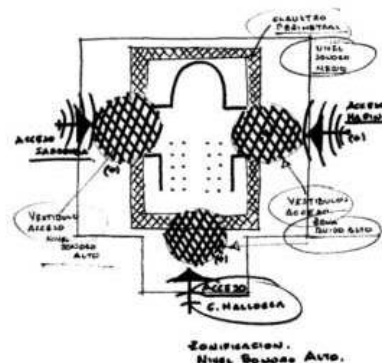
Planta indicando la zonificación sonora general en la Sagrada Familia.
